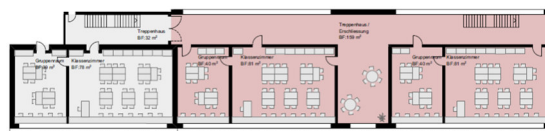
Disposition 01 | Grundriss 1. Obergeschoss
